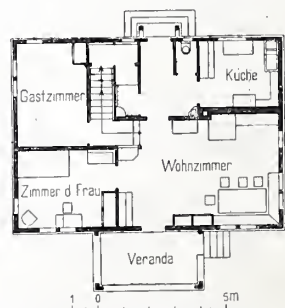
Grundriss vom Erdgeschoss des Sommerhauses «Rotenhus». — 1:400.
